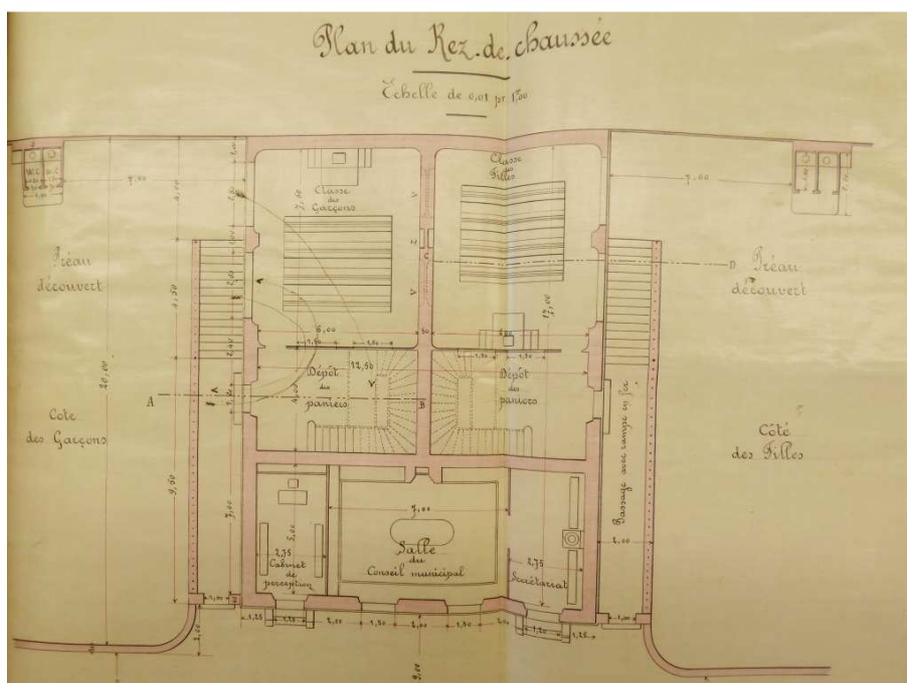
Projet de construction d'une maison d'école avec mairie, plan du rez-de-chaussée, Angeli (conducteur des Ponts et Chaussées).
